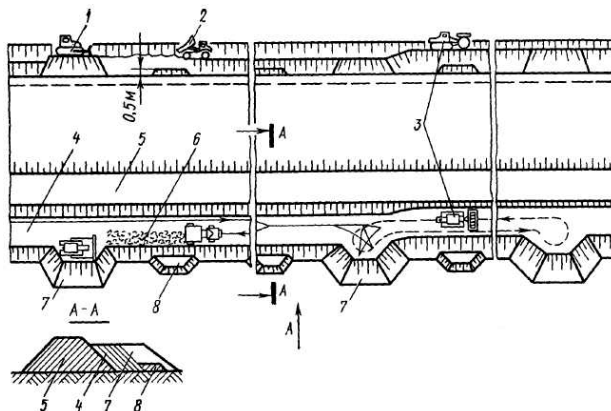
Схема отсыпки насыпи на болоте с двухполосным производством работ: 1 – бульдозер; 2 – автосамосвал; 3 – грунтоуплотняющая машина; 4 – насыпь второго пути; 5 – насыпь первого пути; 6 – отсыпaeмый грунт; 7 – основной разезд; 8 – вспомогательный разезд
